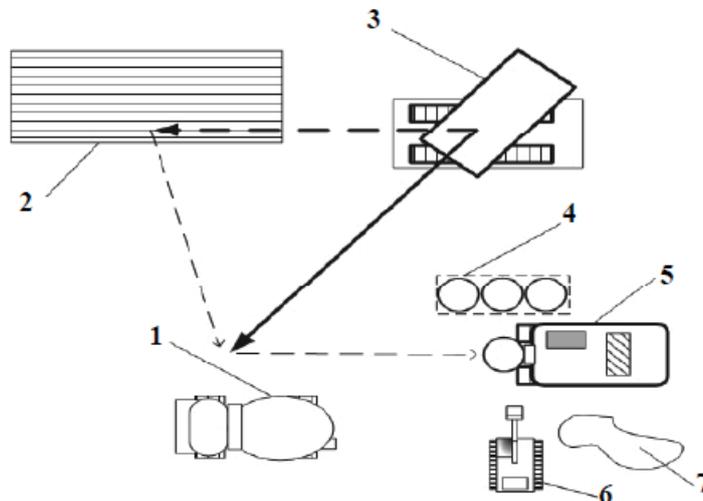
План-схема організації робіт під час влаштування бурових паль під захистом обсадних труб: 1 – автобетонозов; 2 – арматурні каркаси; 3 – кран; 4 – ділянка складування обсадних і бетонолитних труб; 5 – бурова установка; 6 – гідравлічний екскаватор; 7 – відвал ґрунту
